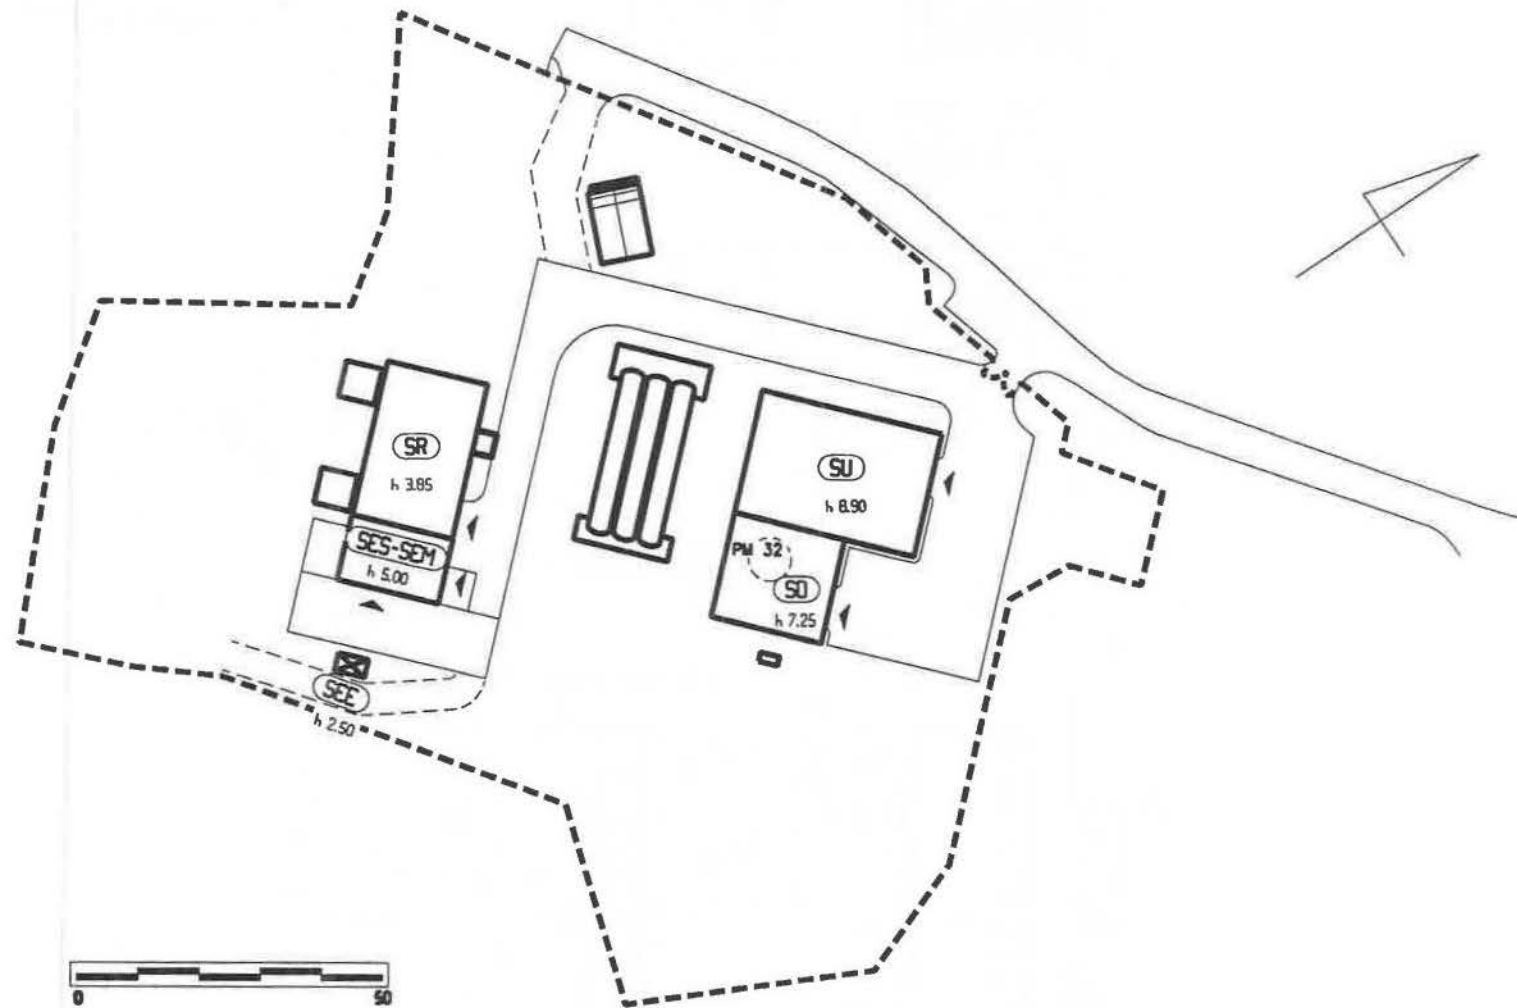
Point 32 : Plan de masse des bâtiments en surface du LHC
